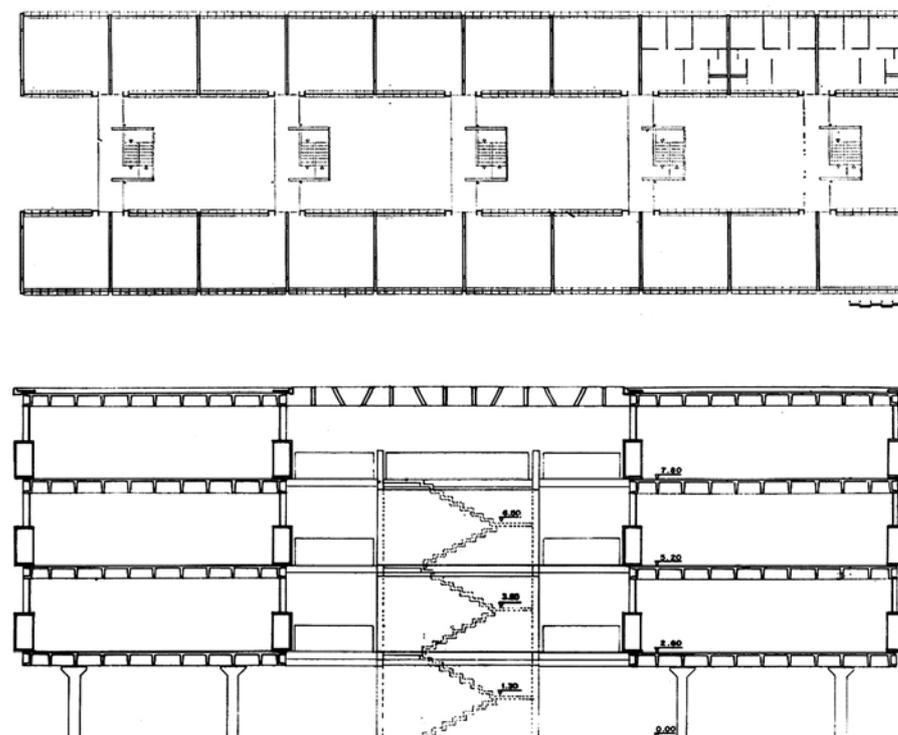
e 24 – Conjunto Zezinho Magalhães Prado, pavimento tipo e corte transversal
